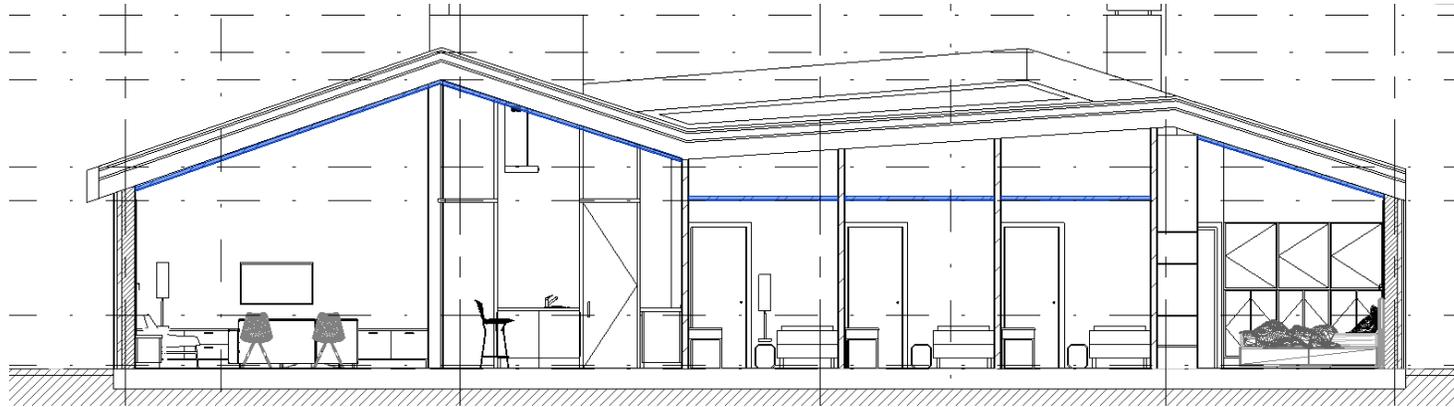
Sección falso techo. Fuente: Elaboración propia.
